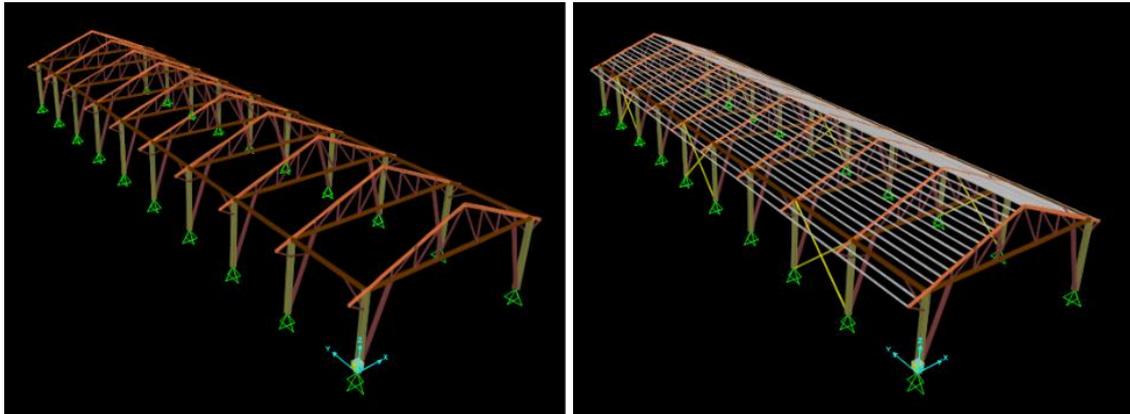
Vista en perspectiva de la estructura. Fuente: Propia
